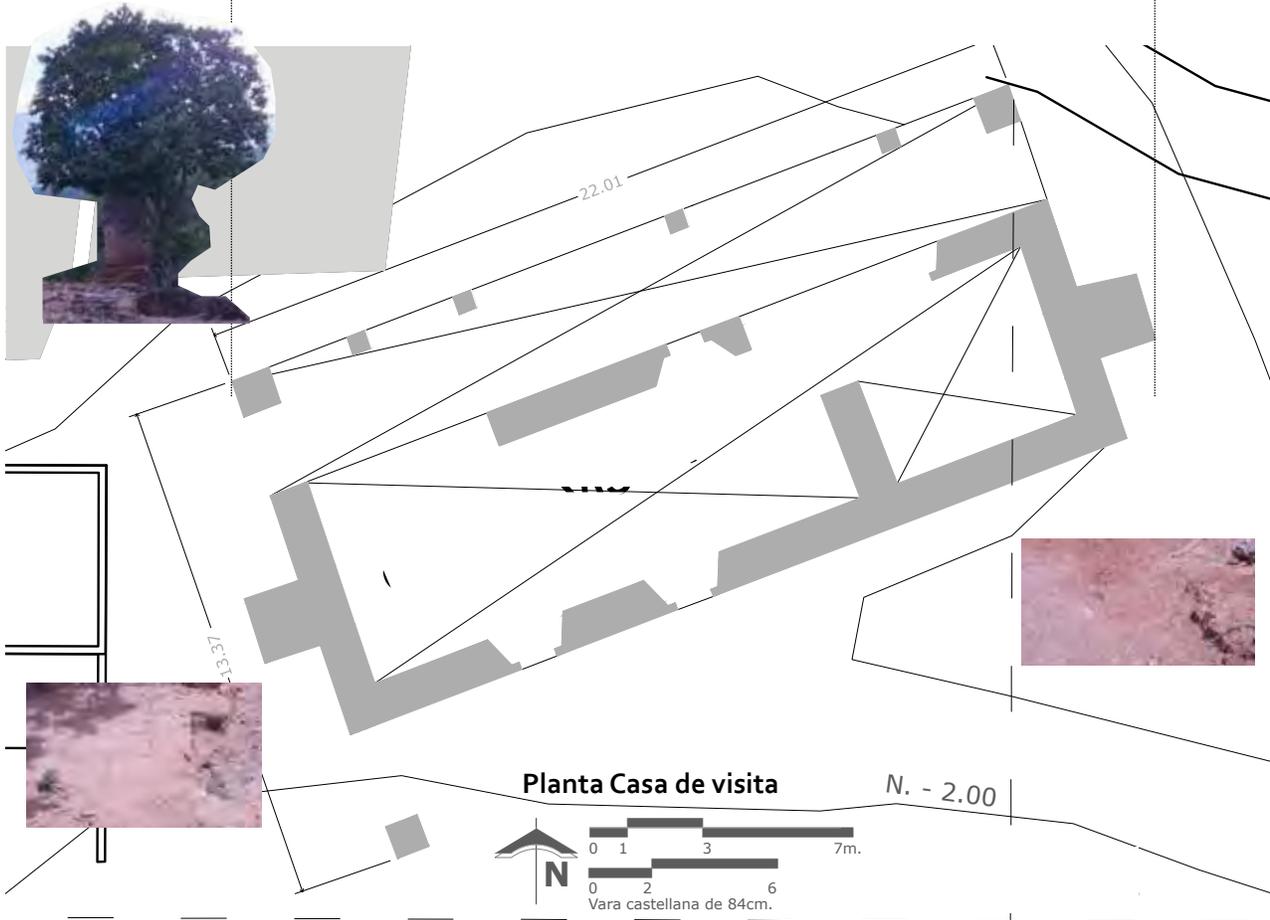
Vestigios de adobe muros interiores, y pilastra del norponiente. KFF, 2013
